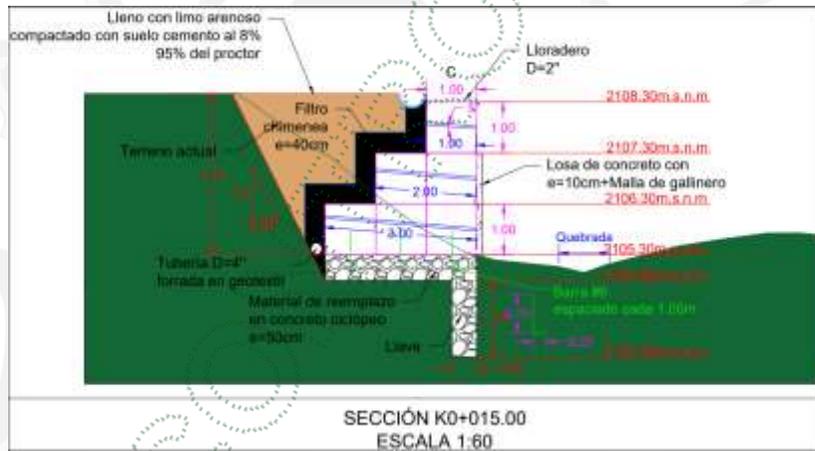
Tipo de la Obra: Muro en gaviones
